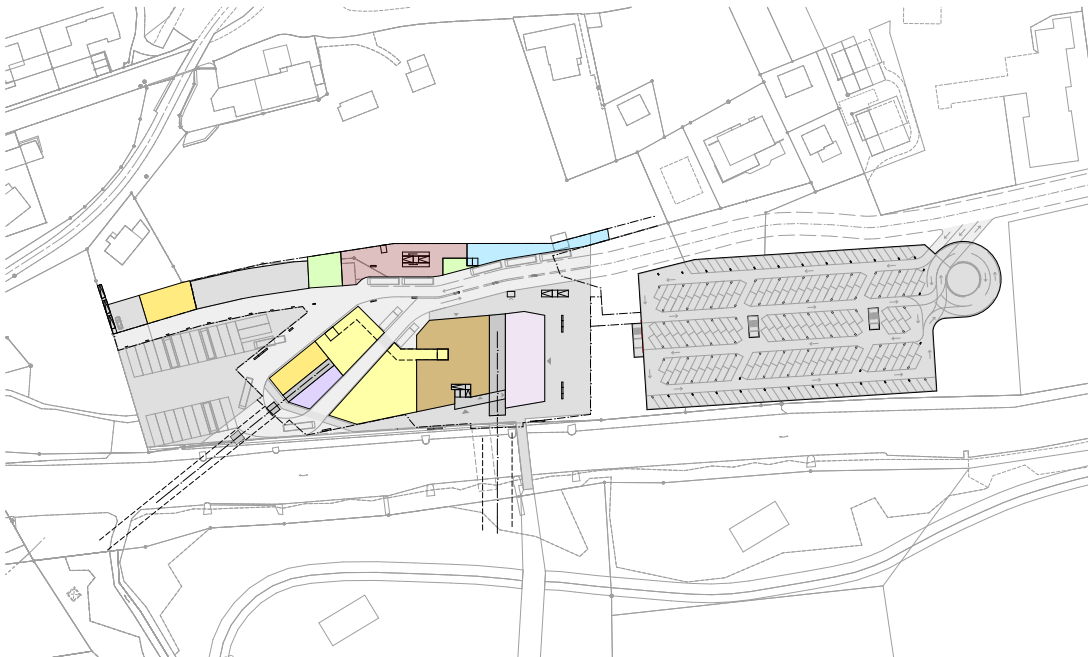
Talstation Grund, Situation EG mit Parkhaus
